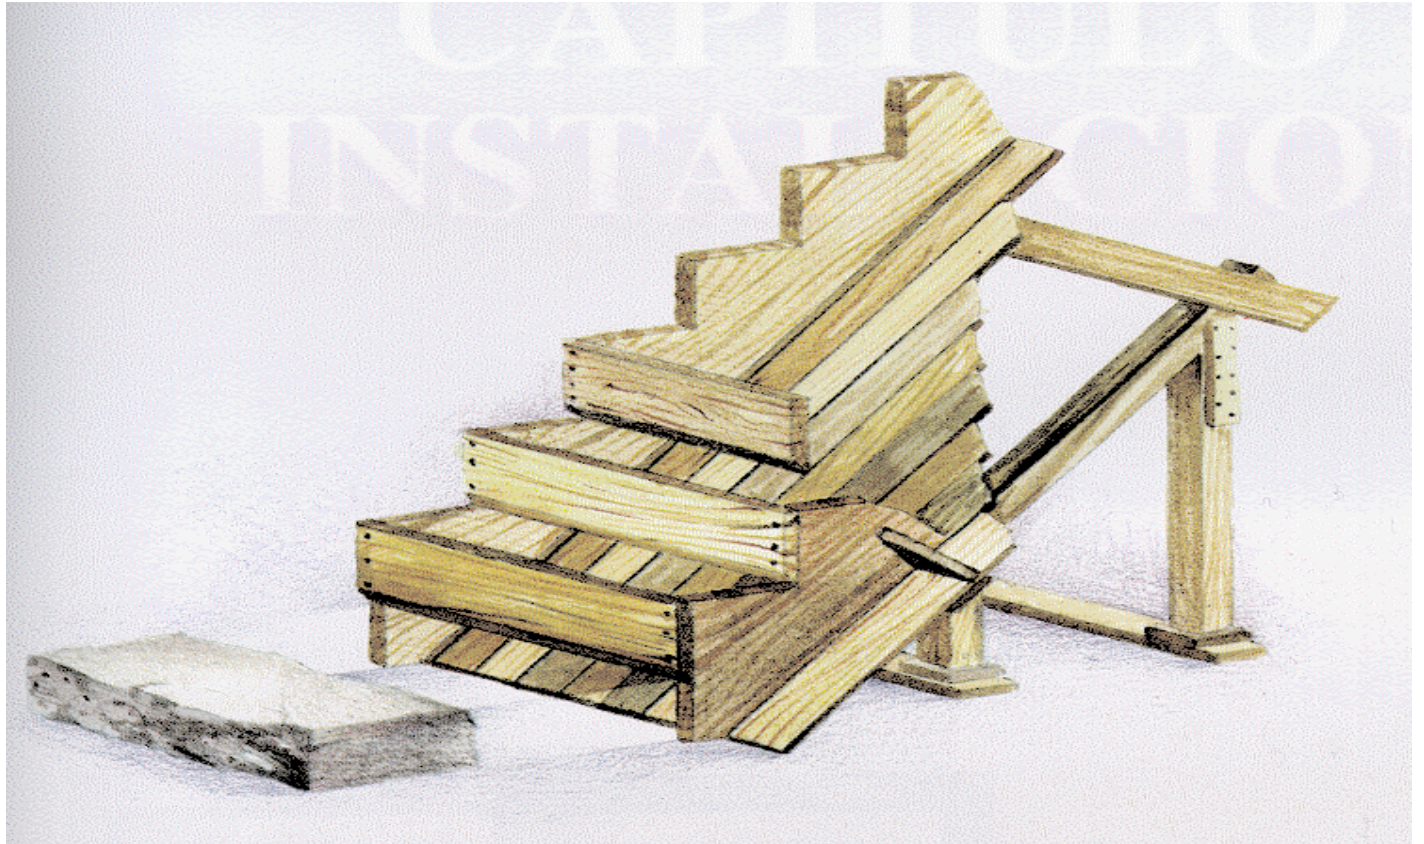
Elementos y refuerzos de la cimbra para construir una escalera.
